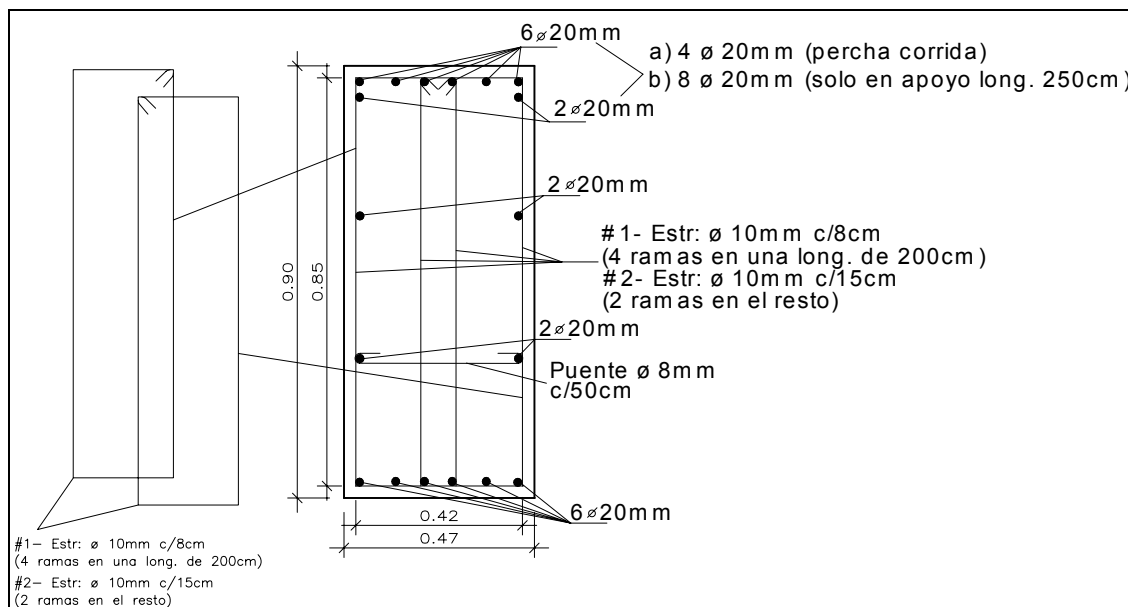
Detalle de disposición de armaduras en vigas soporte de la superestructura, ubicada por encima del sistema de aislamiento, tramo central (Ver también Capítulo 9).
